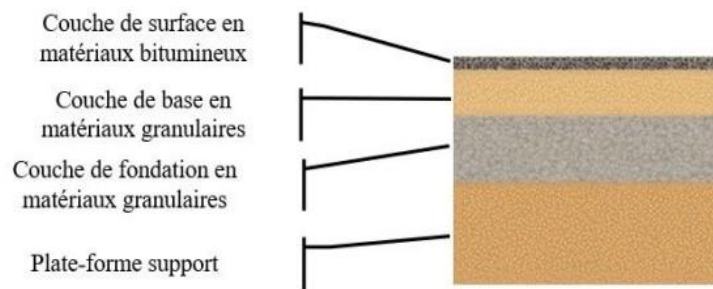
Structure d'une chaussée souple (Nguyen, 2008).
